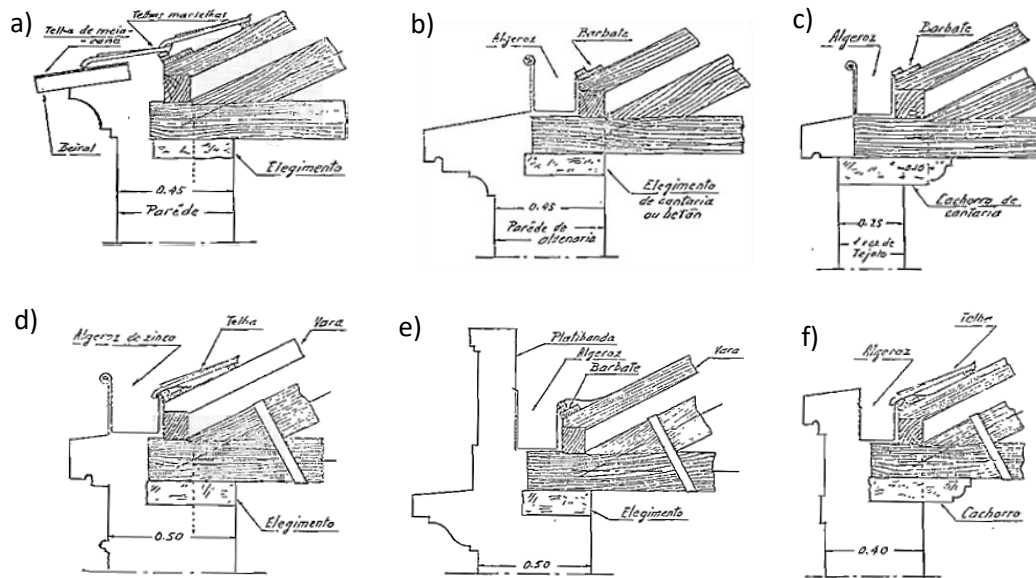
Pormenores dos apoios da asna na parede (Costa, 1955): a) Apoio de asna para telhado com beiral; b) Apoio de asna para telhado com algeroz à vista; c) Apoio de asna para telhado com algeroz à vista sobre uma parede de tijolo; d) Apoio de asna para telhado de algeroz descarregando a um terço da espessura da parede; e) Apoio de asna para telhado de algeroz e platibanda; f) Apoio de asna para telhado de algeroz sobre parede
